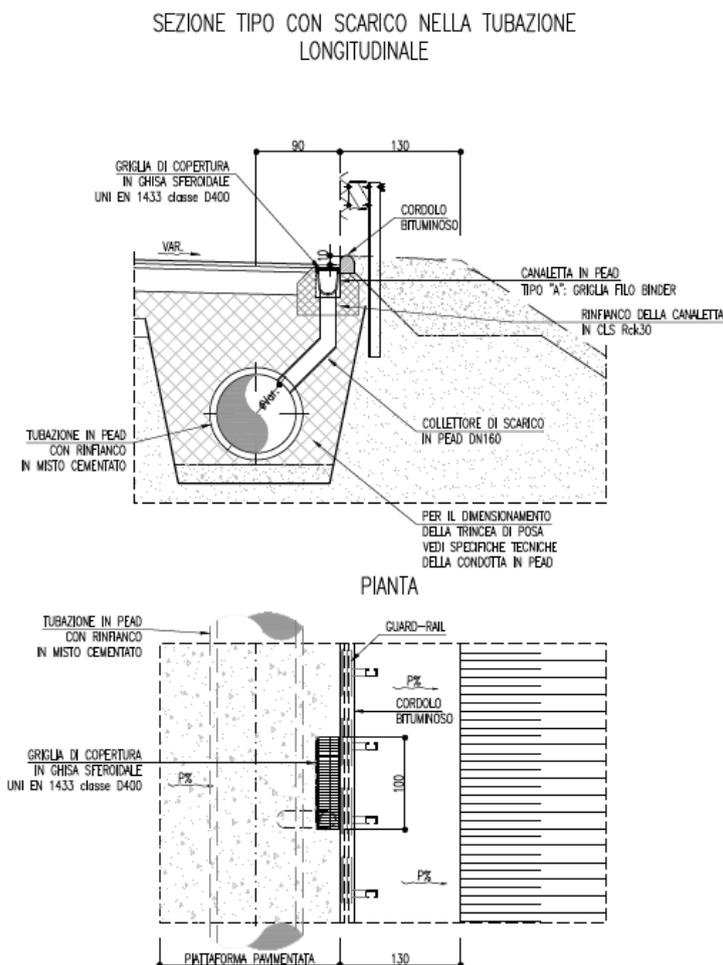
Sezione tipo del sistema di drenaggio con canaletta discontinua.
